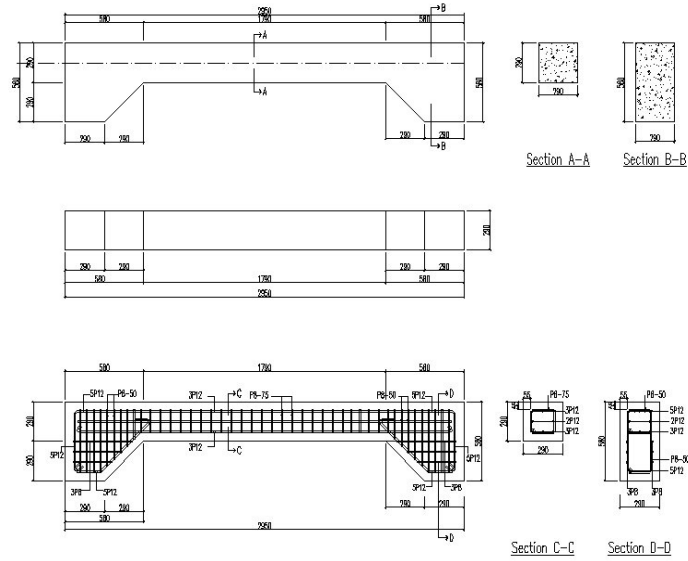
Detail dan Konfigurasi Penulangan Benda Uji Kolom C
